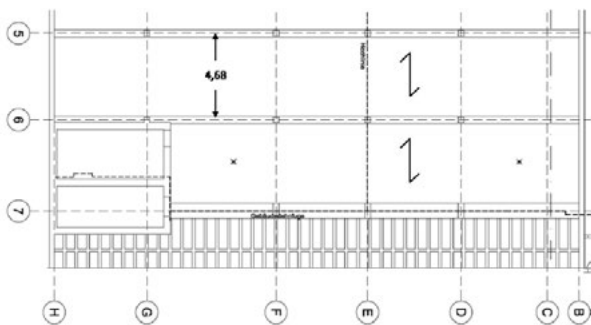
Grundriss der Tiefgaragendecke (Ausschnitt)
